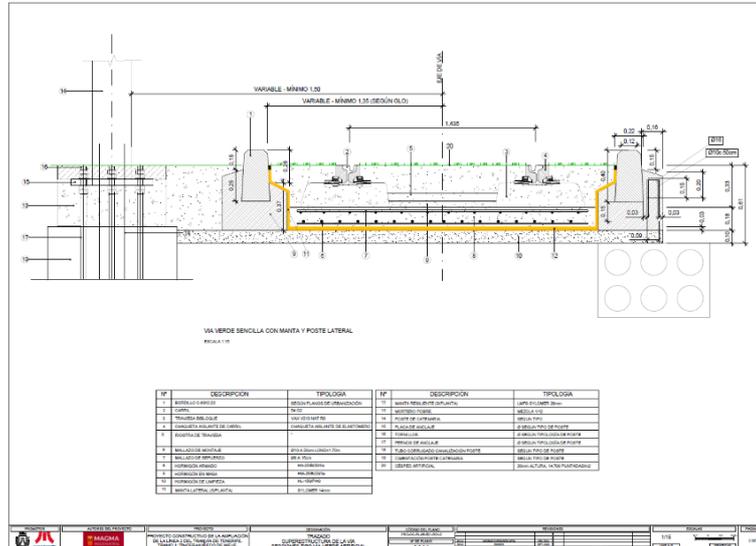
Sección tipo-vía verde artificial. Fuente: Proyecto constructivo.
